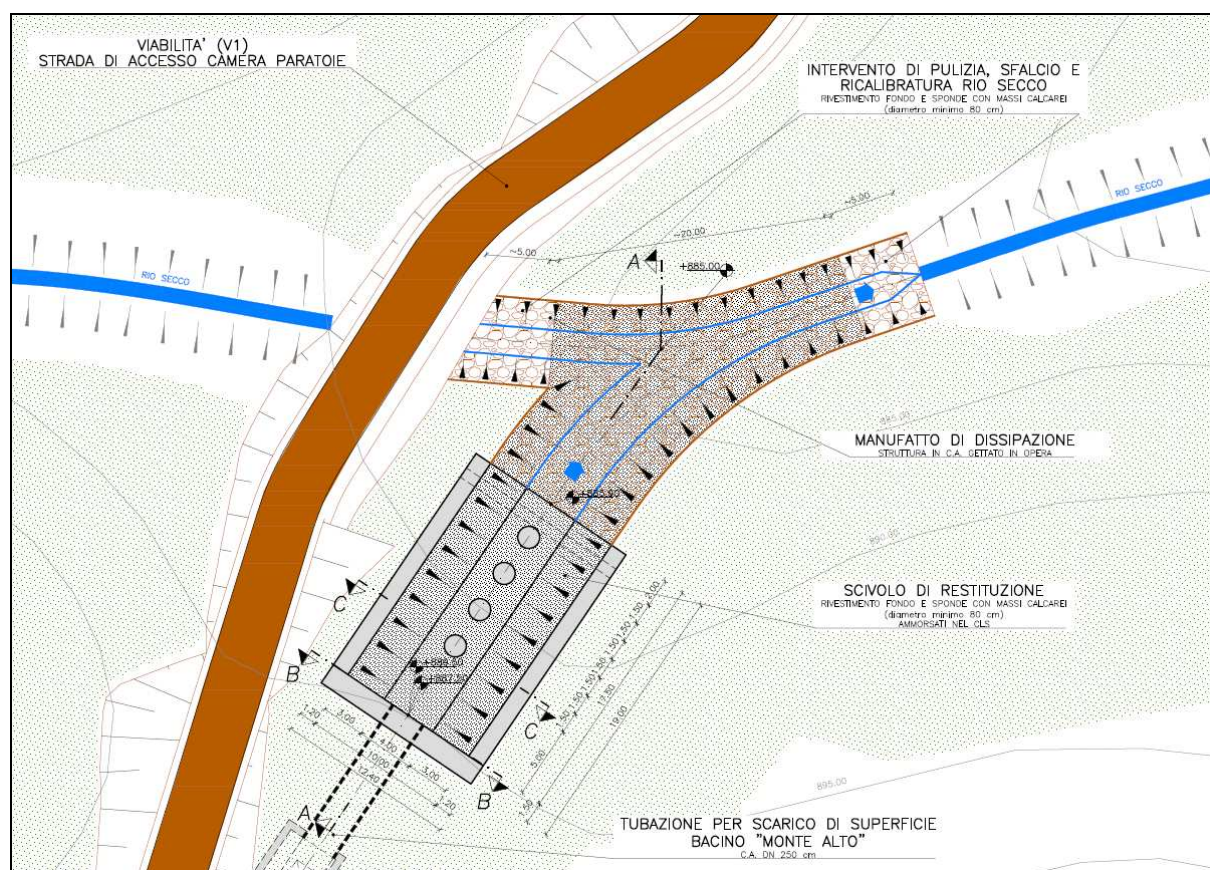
Planimetria manufatto di scarico nel Rio Secco
